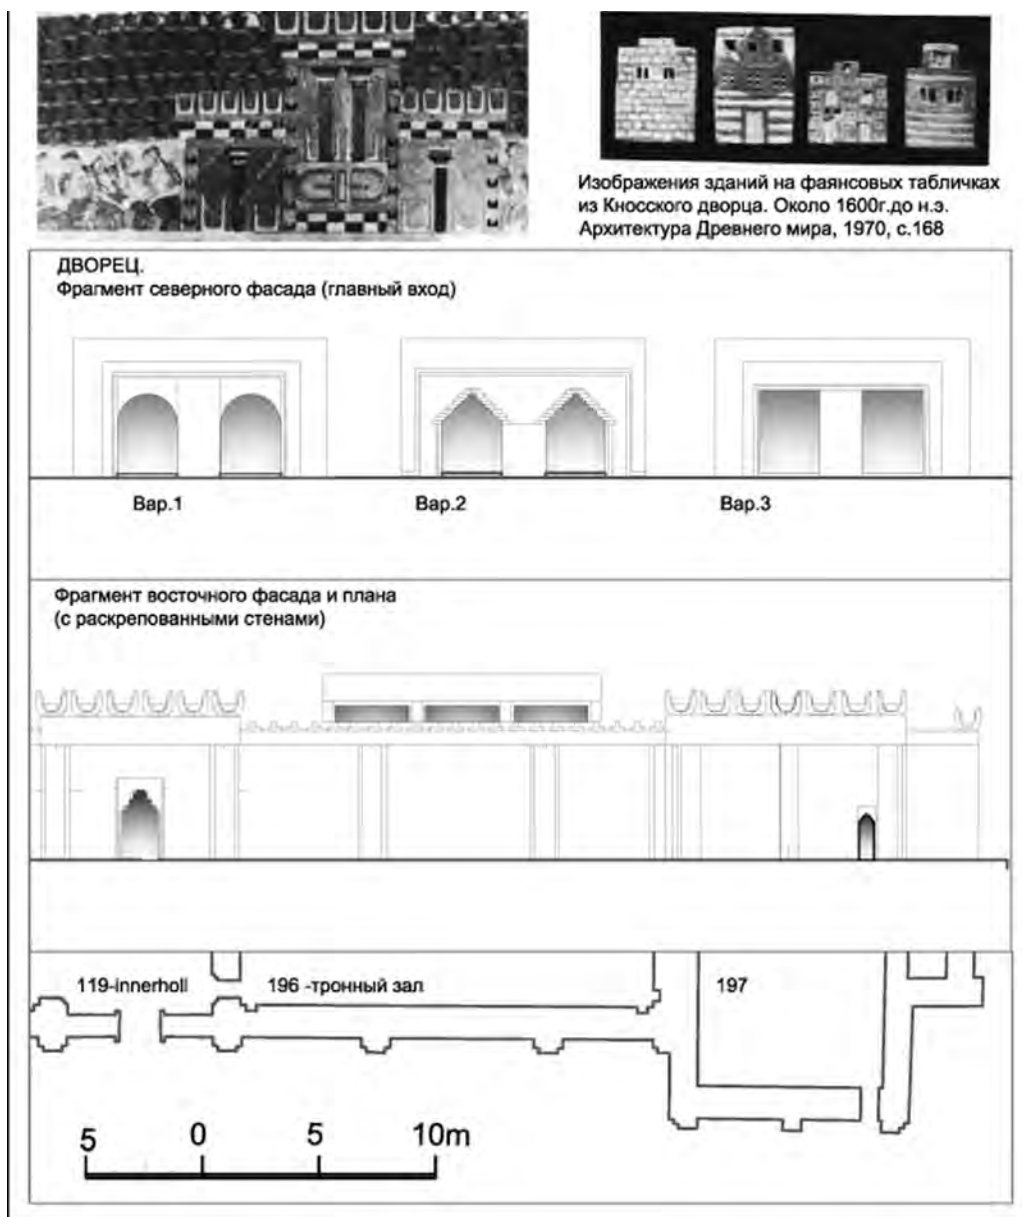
Дворец. Схема реконструкции фрагментов восточного и северного фасада
